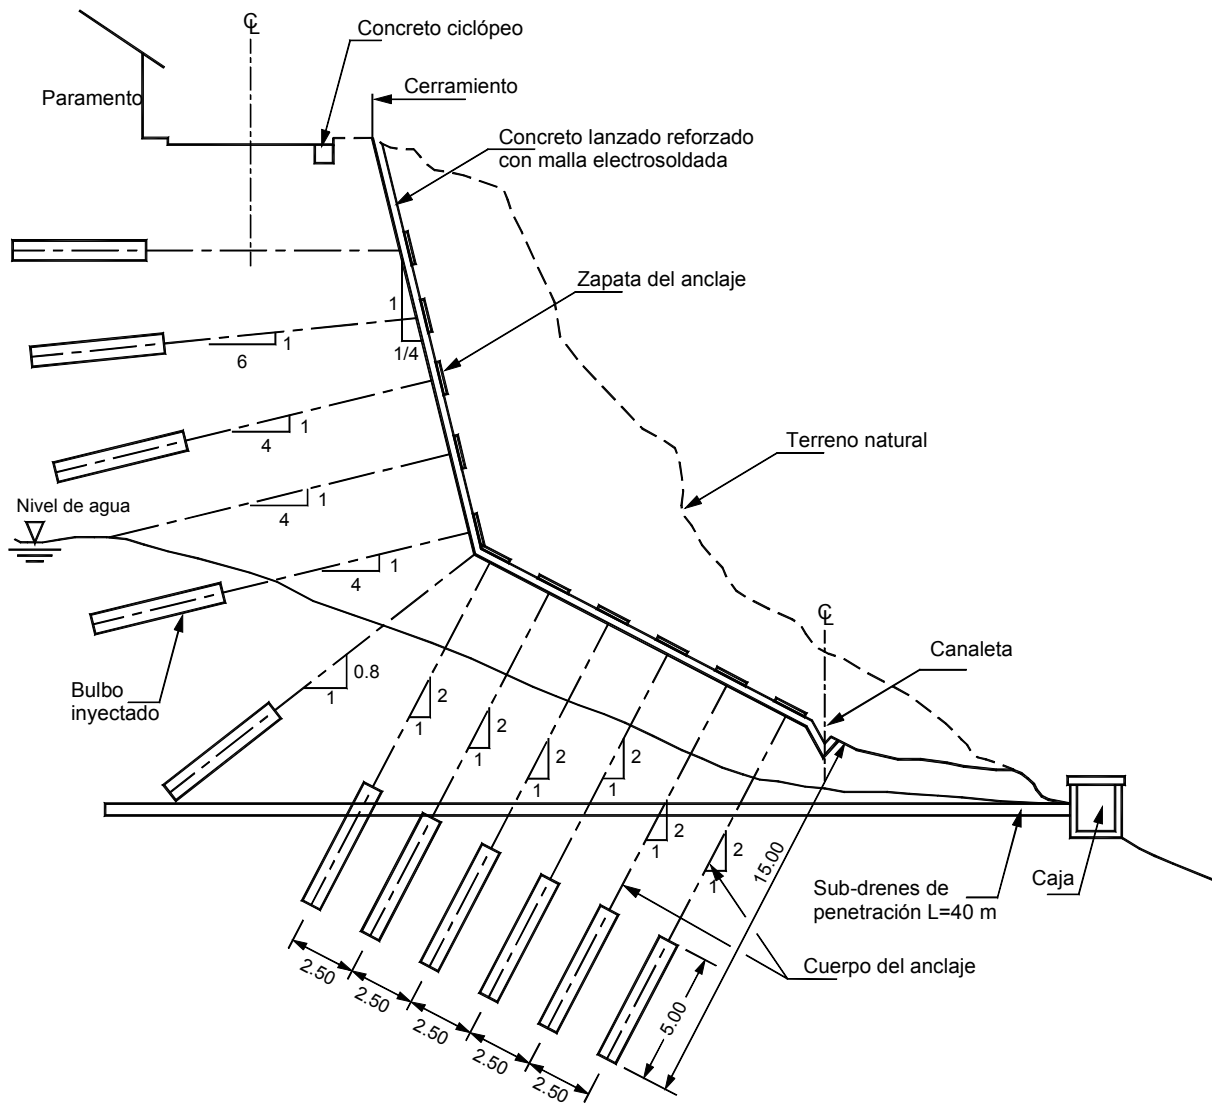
Detalle de pantalla en concreto lanzado anclada.
